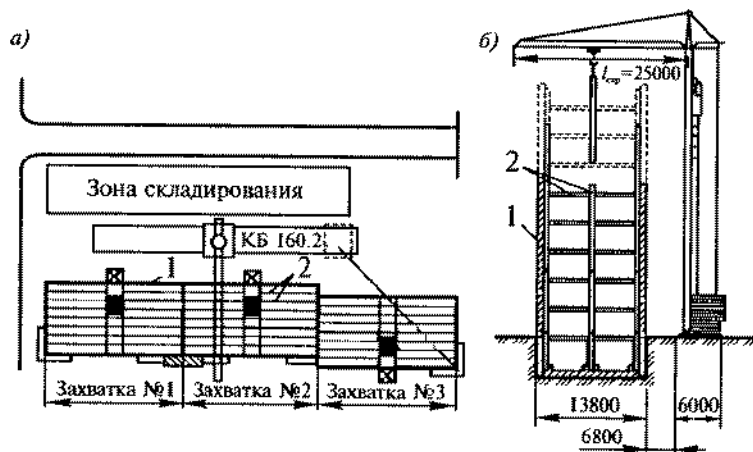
Схема реконструкции жилого дома со встроенным каркасом:
